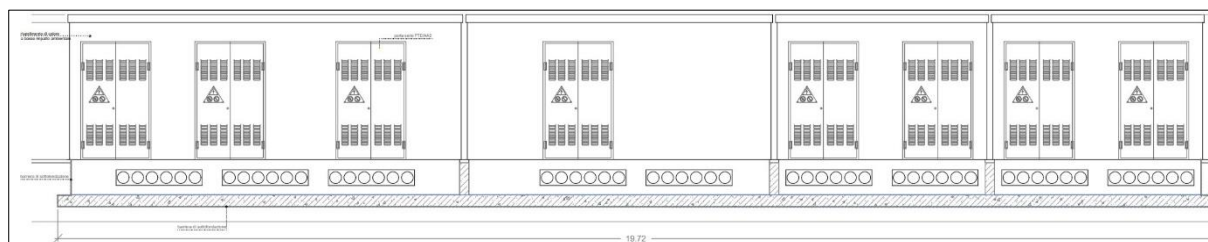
Prospetto struttura di fondazione cabina di centrale
